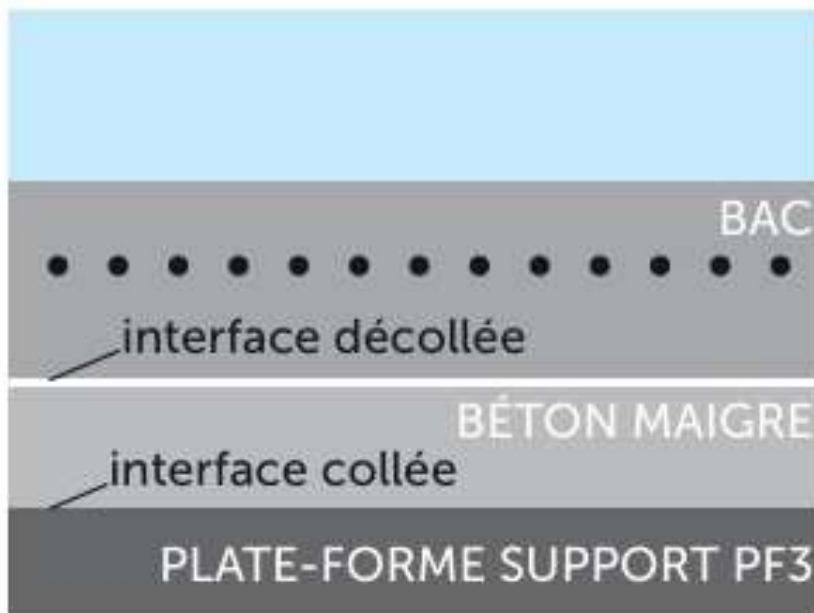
Structure BAC classique (BAC/ Béton maigre) avec collage entre fondation et plate-forme et décollement entre BAC et béton maigre.
